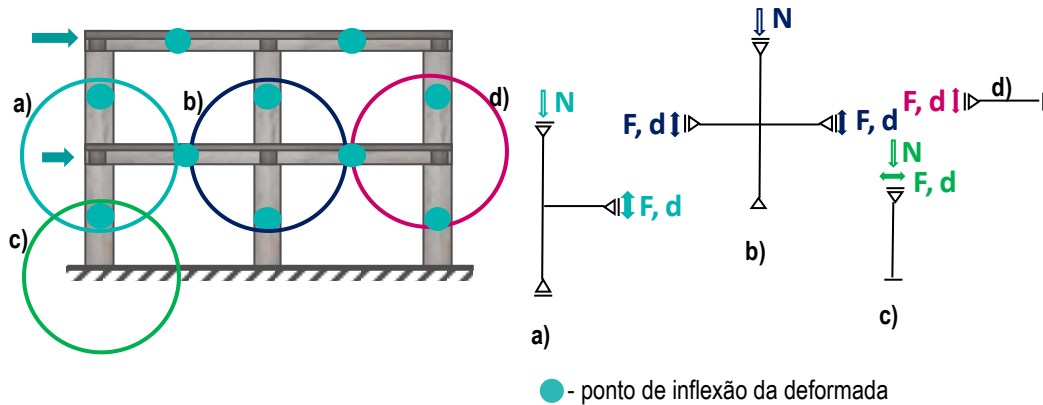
Sub-estruturação – Esquema da configuração do ensaio: (a) modelo viga-pilar de extremidade; (b) modelo viga-pilar interior; (c) modelo de pilar; (d) modelo de viga [adaptado de Proença, IST]
